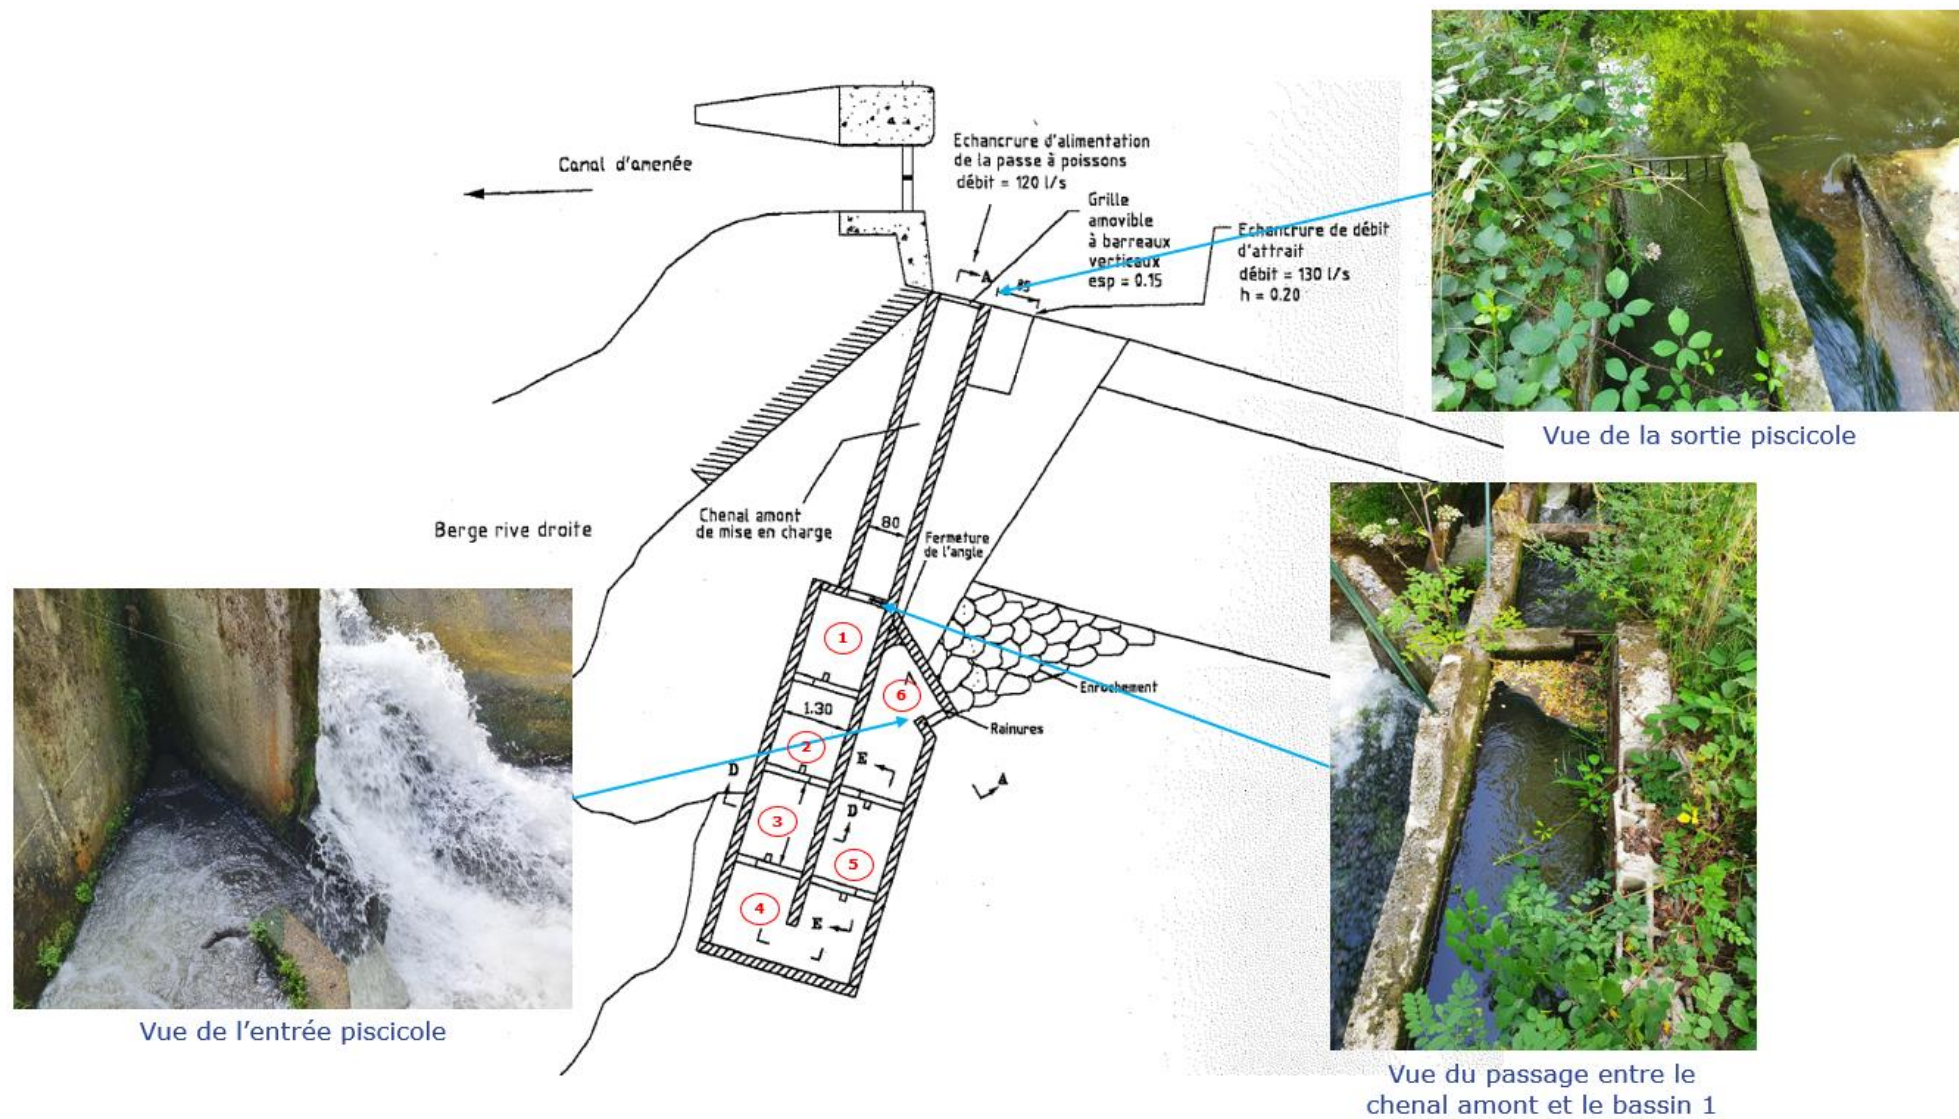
Vue en plan de la passe à poissons actuelle et photographies
